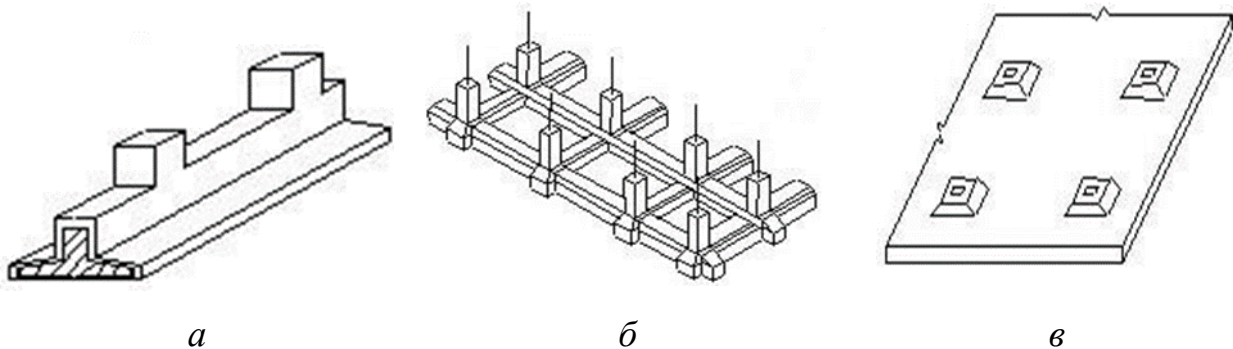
Типи гнучких фундаментів мілкого закладання:
